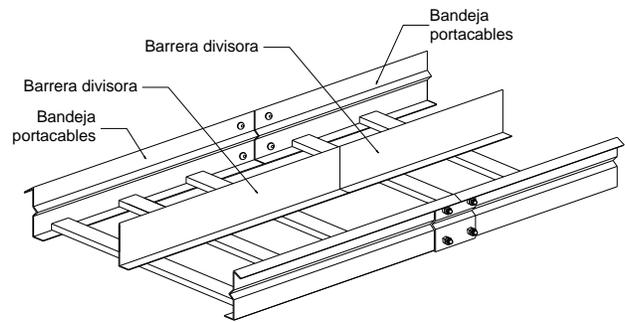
Separación de cables en bandejas portacables mediante barreras o divisores
